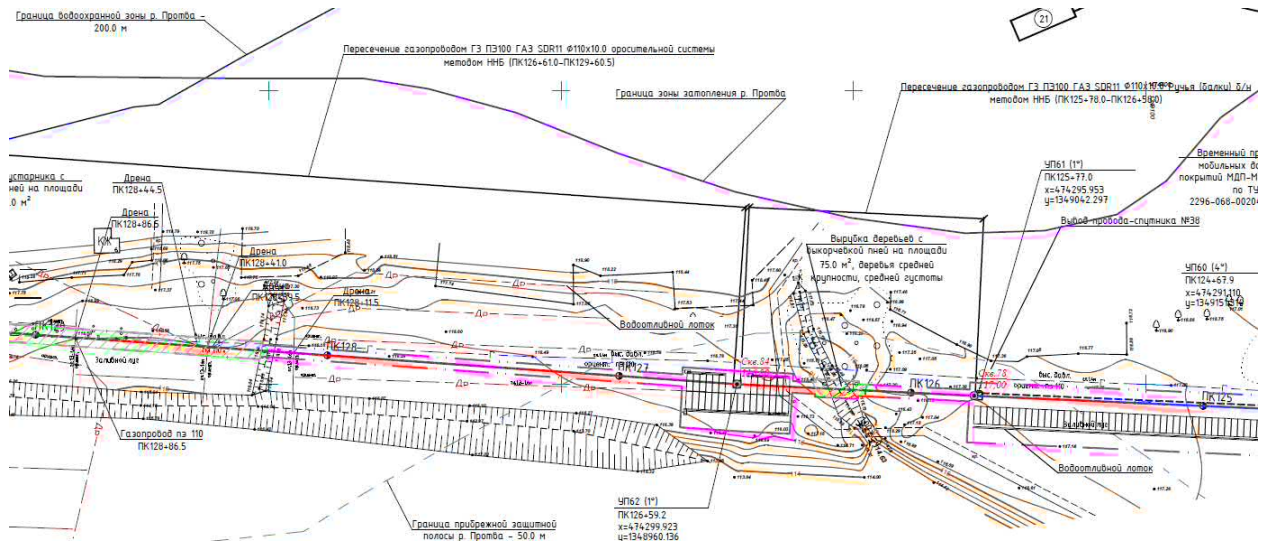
План перехода ручей (балка) б/н (ПК125+78.0 - ПК126+58.0)
